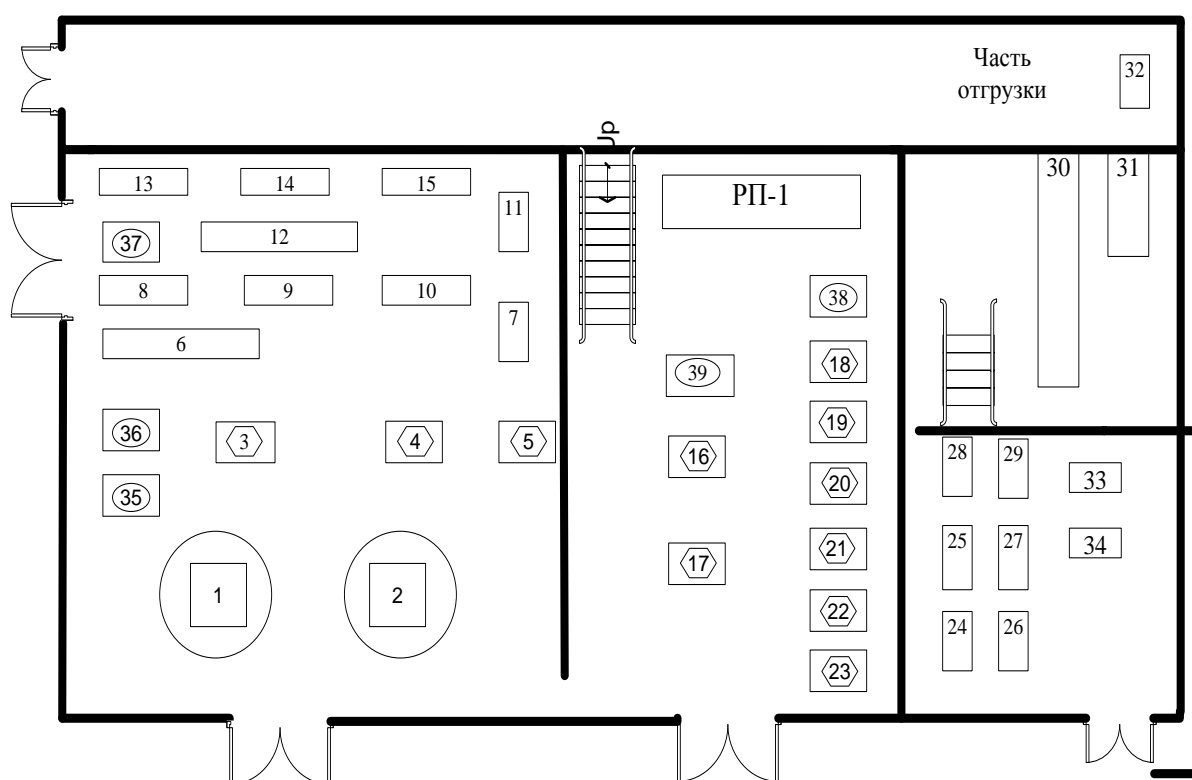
План 1-го этажа фильтровально-сушильного отделения.
